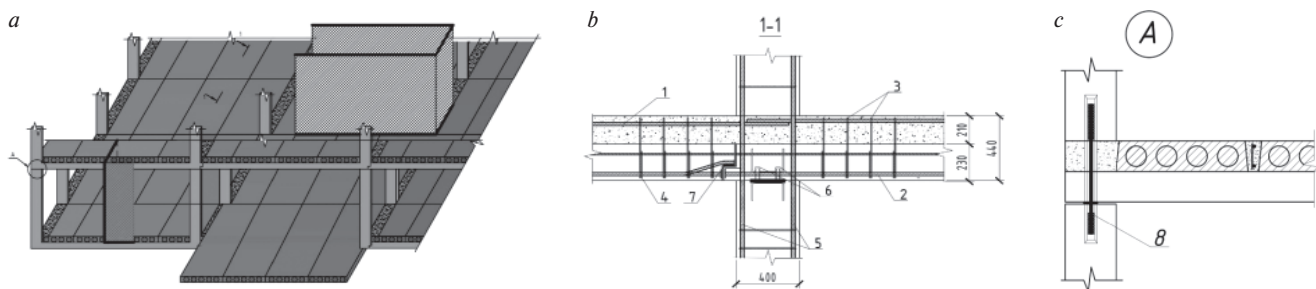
Конструктивная система сборно-монолитного здания из панельно-рамных элементов: а – фрагмент каркаса; б – разрез 1–1; с – схема соединения сборных панельно-рамных элементов по высоте: 1 – рабочая арматура монолитной части ригеля; 2 – рабочая арматура сборной части ригеля; 3 – горизонтальные поперечные стержни в монолитной части ригеля; 4 – вертикальные поперечные стержни-выпуски ригеля; 5 – рабочая арматура стойки панельно-рамного элемента; 6 – закладные детали штепсельного стыка; 7 – закладная деталь консоли для опирания L-образного элемента; 8 – накладка
